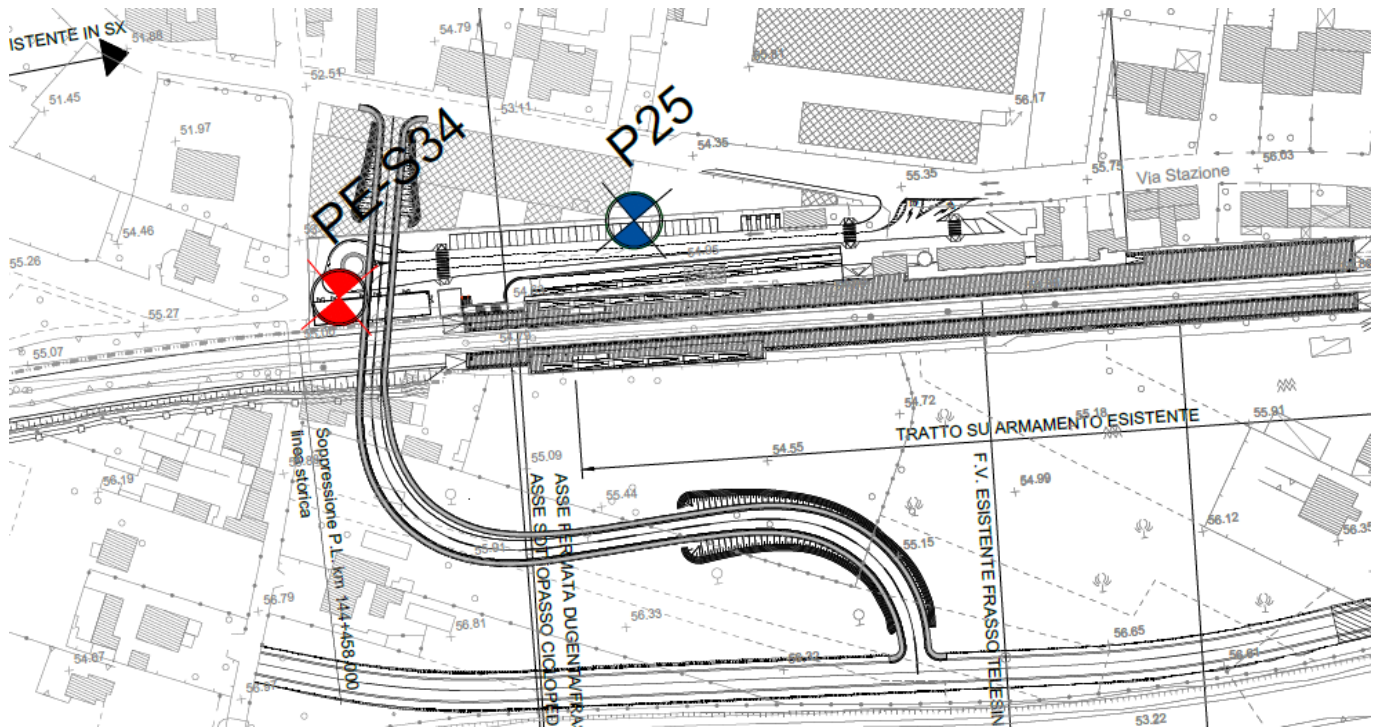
Stralcio della planimetria con ubicazione delle indagini (fuori scala)
